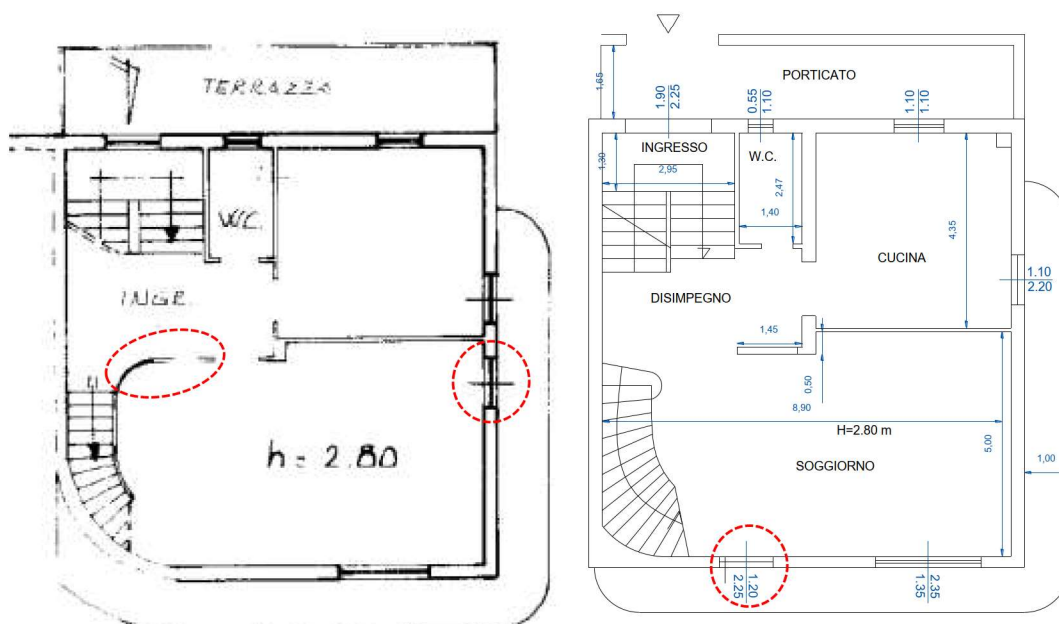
Raffronto planimetria catastale (a sinistra) e planimetria stato di fatto (a destra) - Piano terra
